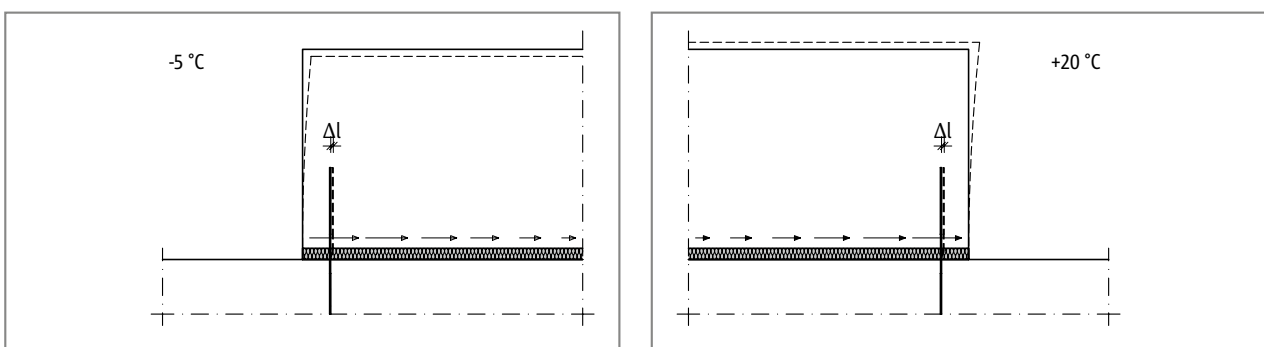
Schöck Isokorb® : Déplacement des barres extérieures d'une dalle de balcon de Δl en raison d'une déformation thermique
